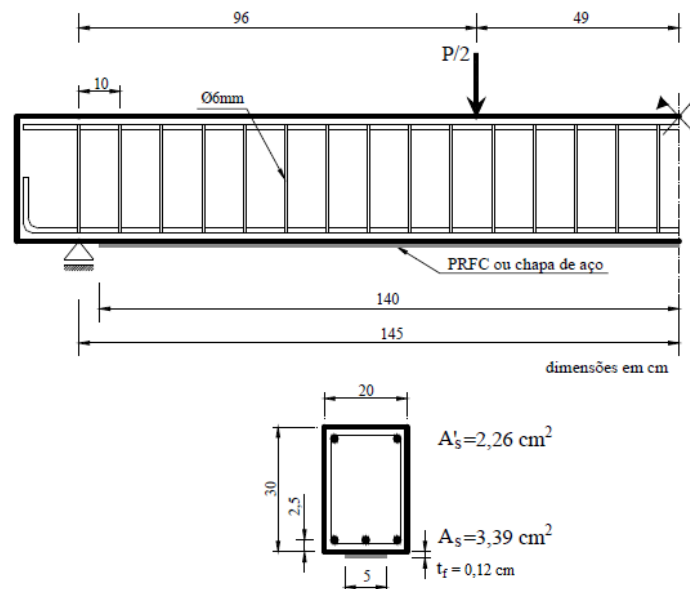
Detalhamento das vigas ensaiadas por Zarnic et. al. [4].
